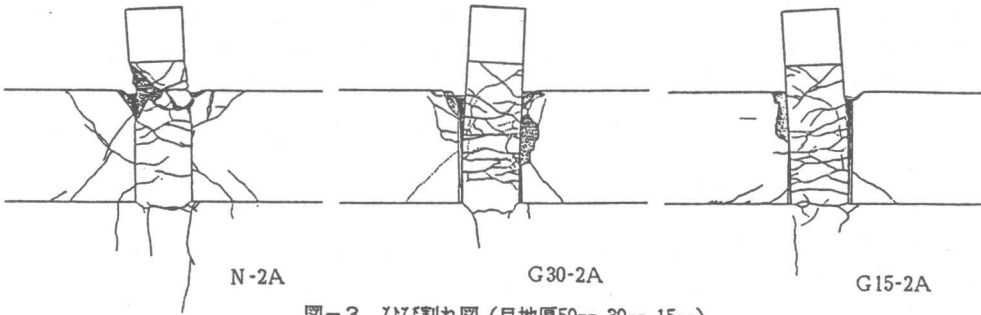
ひび割れ図 (目地厚50mm, 30mm, 15mm)
